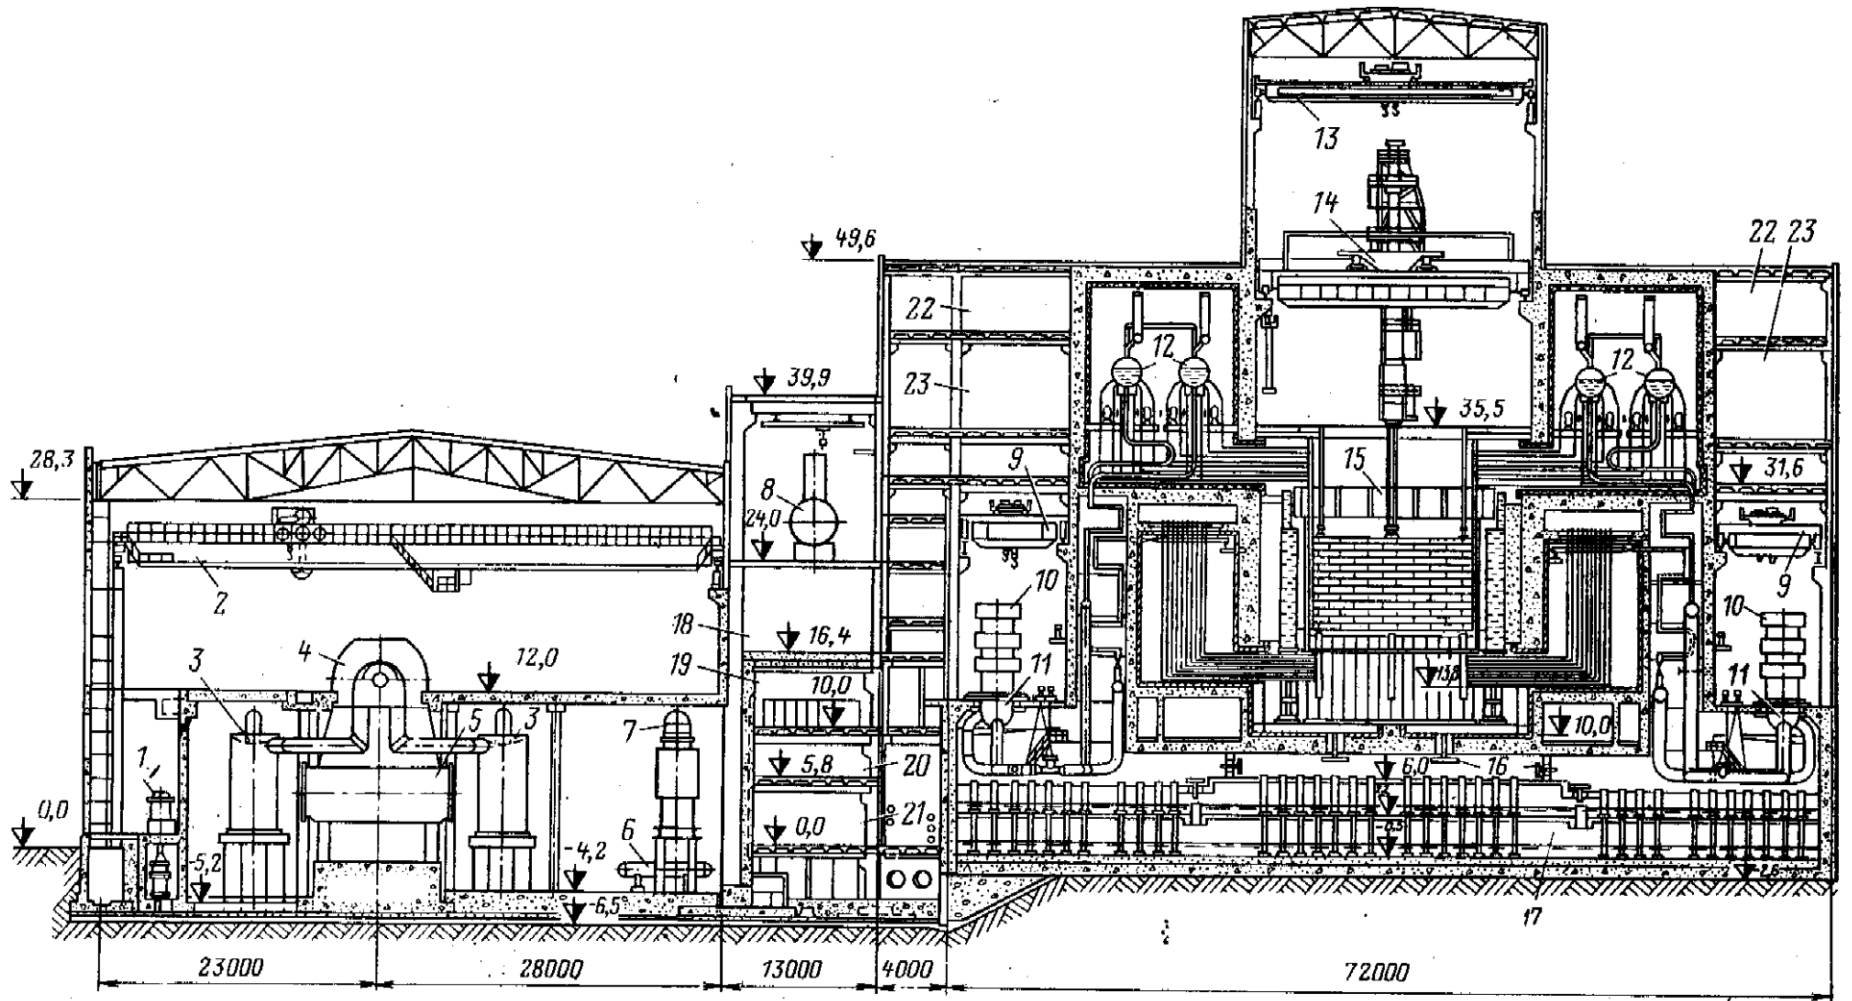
Поперечный разрез главного корпуса АЭС с реактором РБМК-1000:
